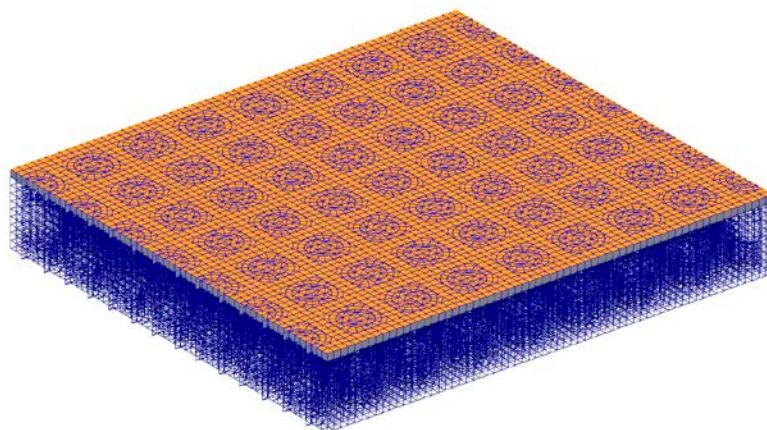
Схема действия постоянной нагрузки на плиту перекрытия со сферическими вкладышами пустотообразователями
